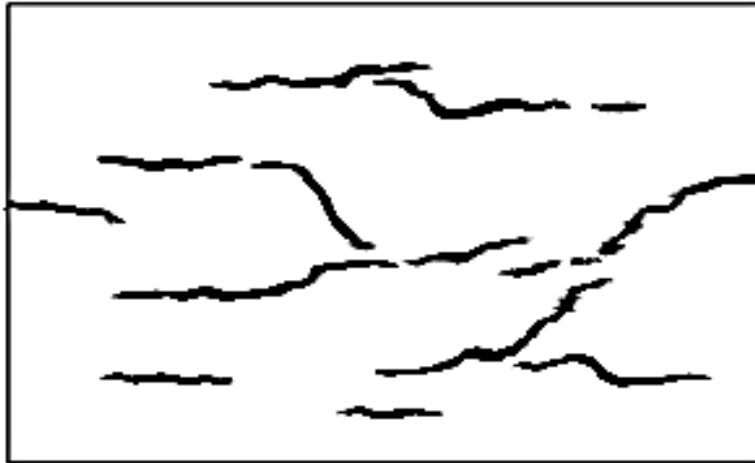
Típica Fisuración por retracción plástica.
